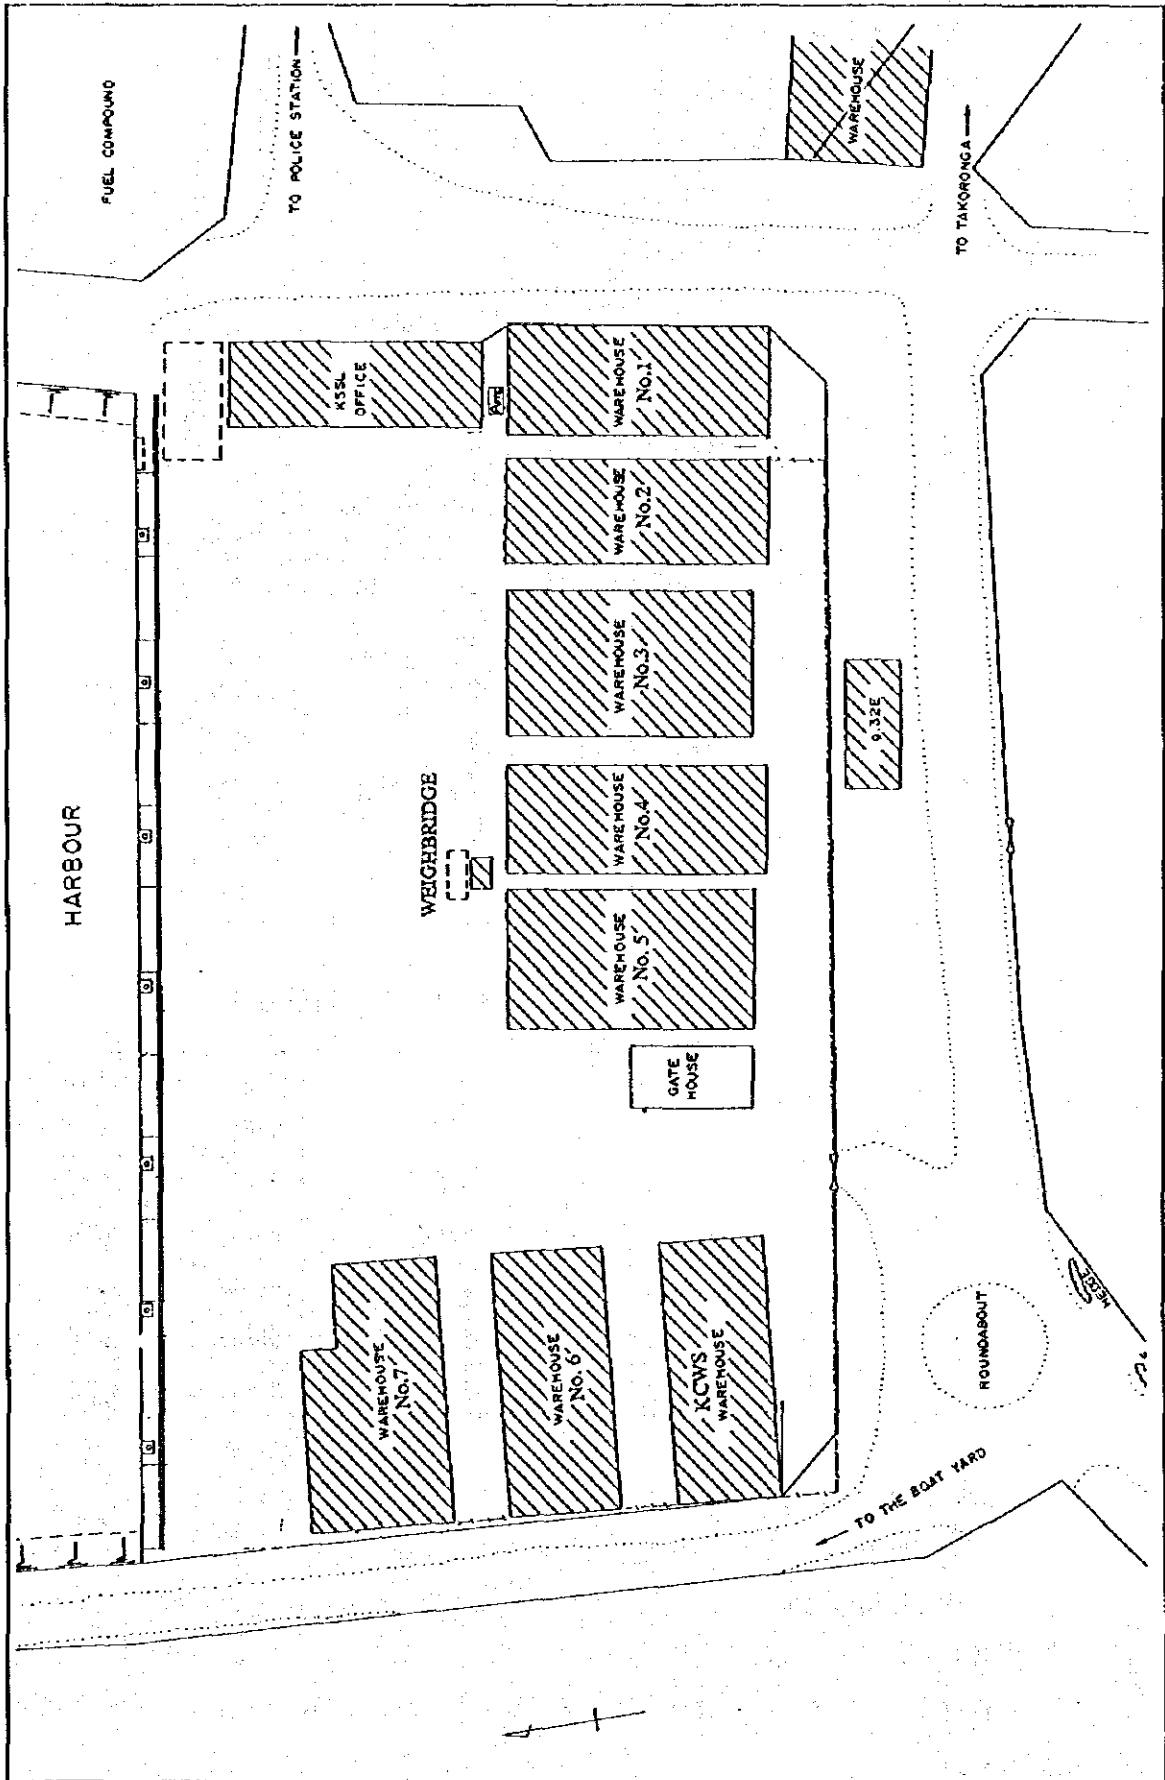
ペシオ港の埠頭用地、上屋、KSSL事務所配置図
